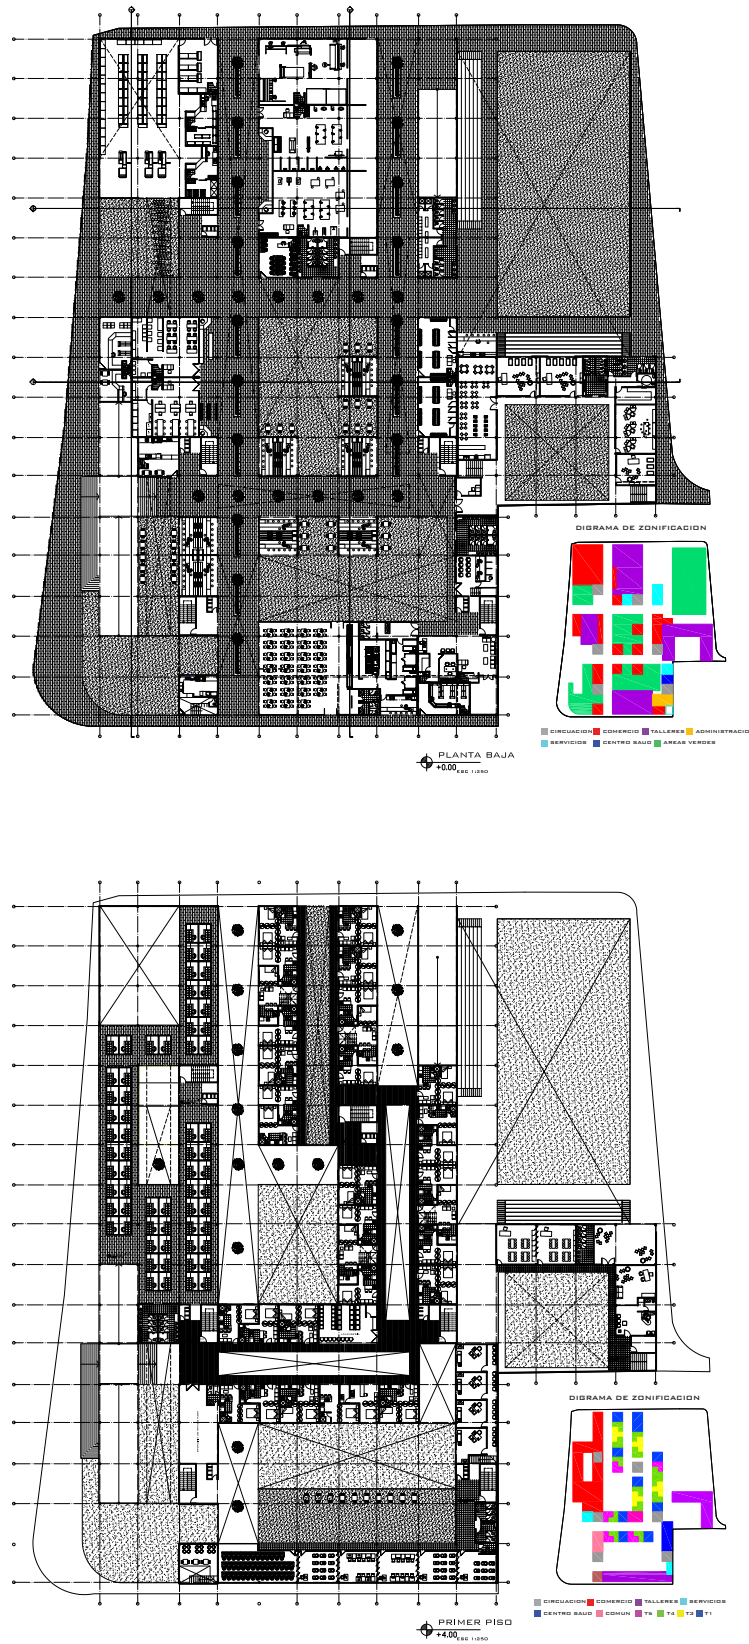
Planta baja y primer piso del proyecto arquitectónico
